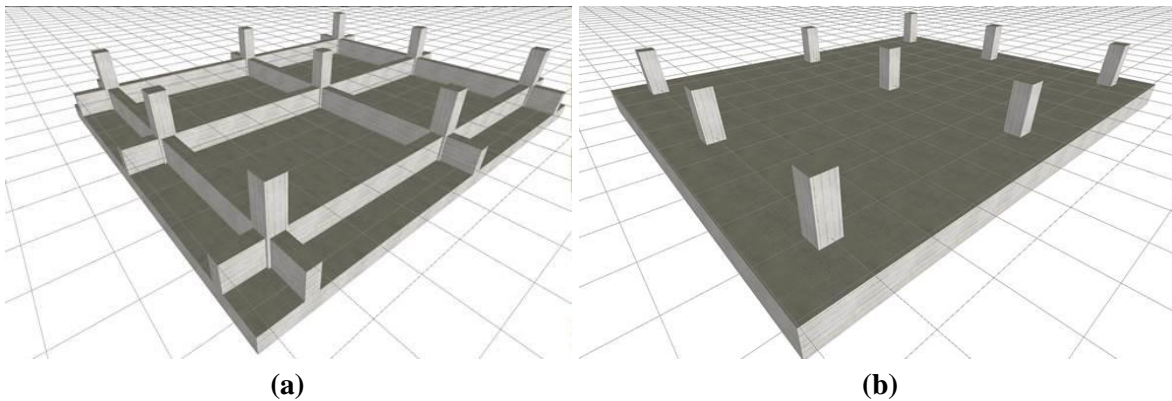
Cimentaciones rígidas para construcciones pequeñas o medianas, a) cimentación rígida con trabes de liga, b) cimentación rígida de tipo simple (Building How, 2015)
